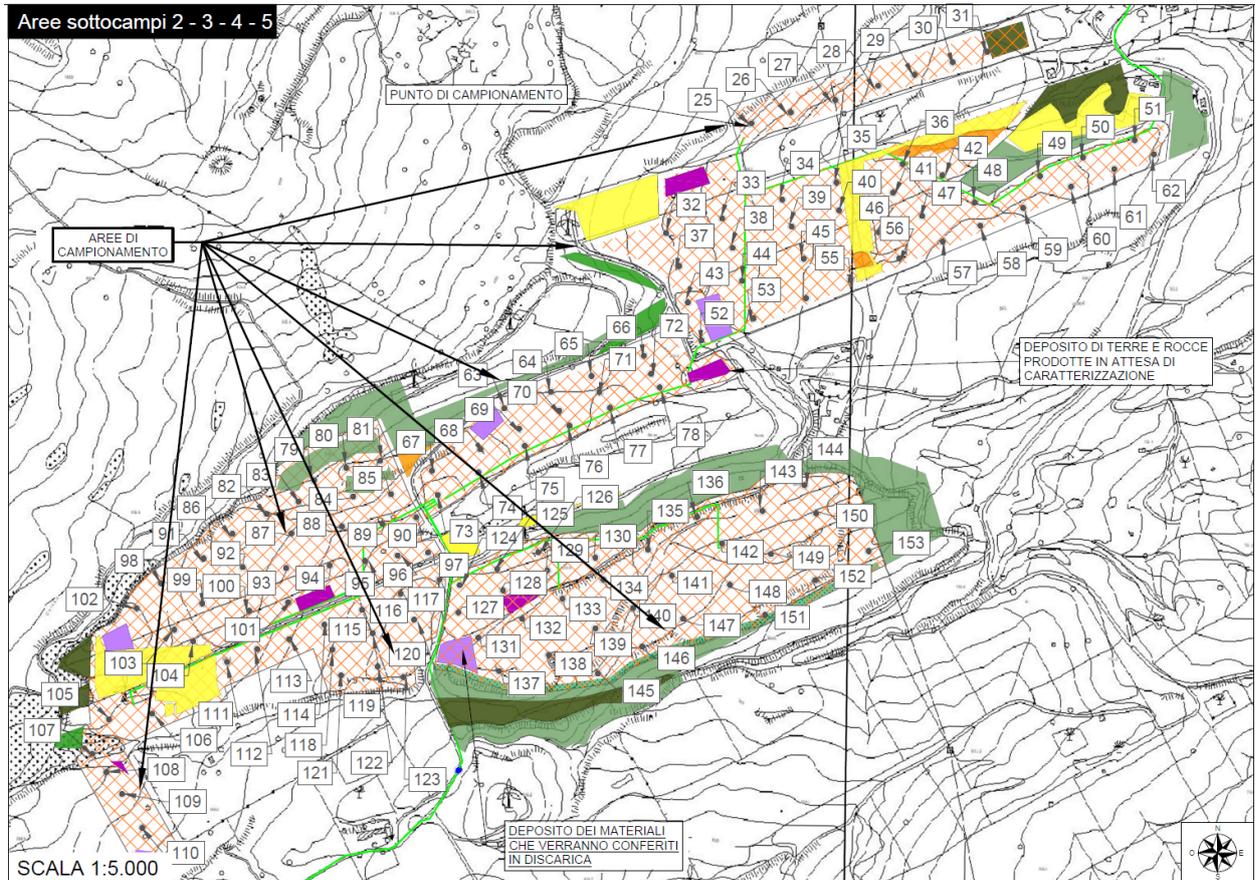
Planimetria sottocampi 2 - 3 - 4 - 5 con punti di campionamento
